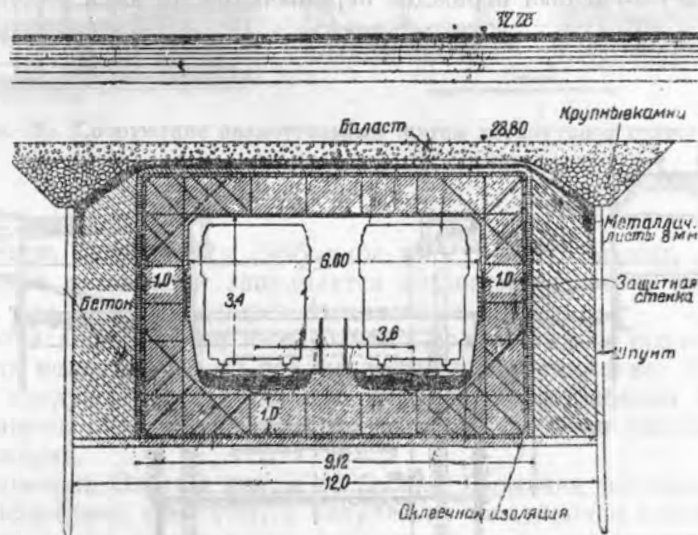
Готовый подводный железобетонный двухпутный тоннель метрополитена под рекой Шпрее
